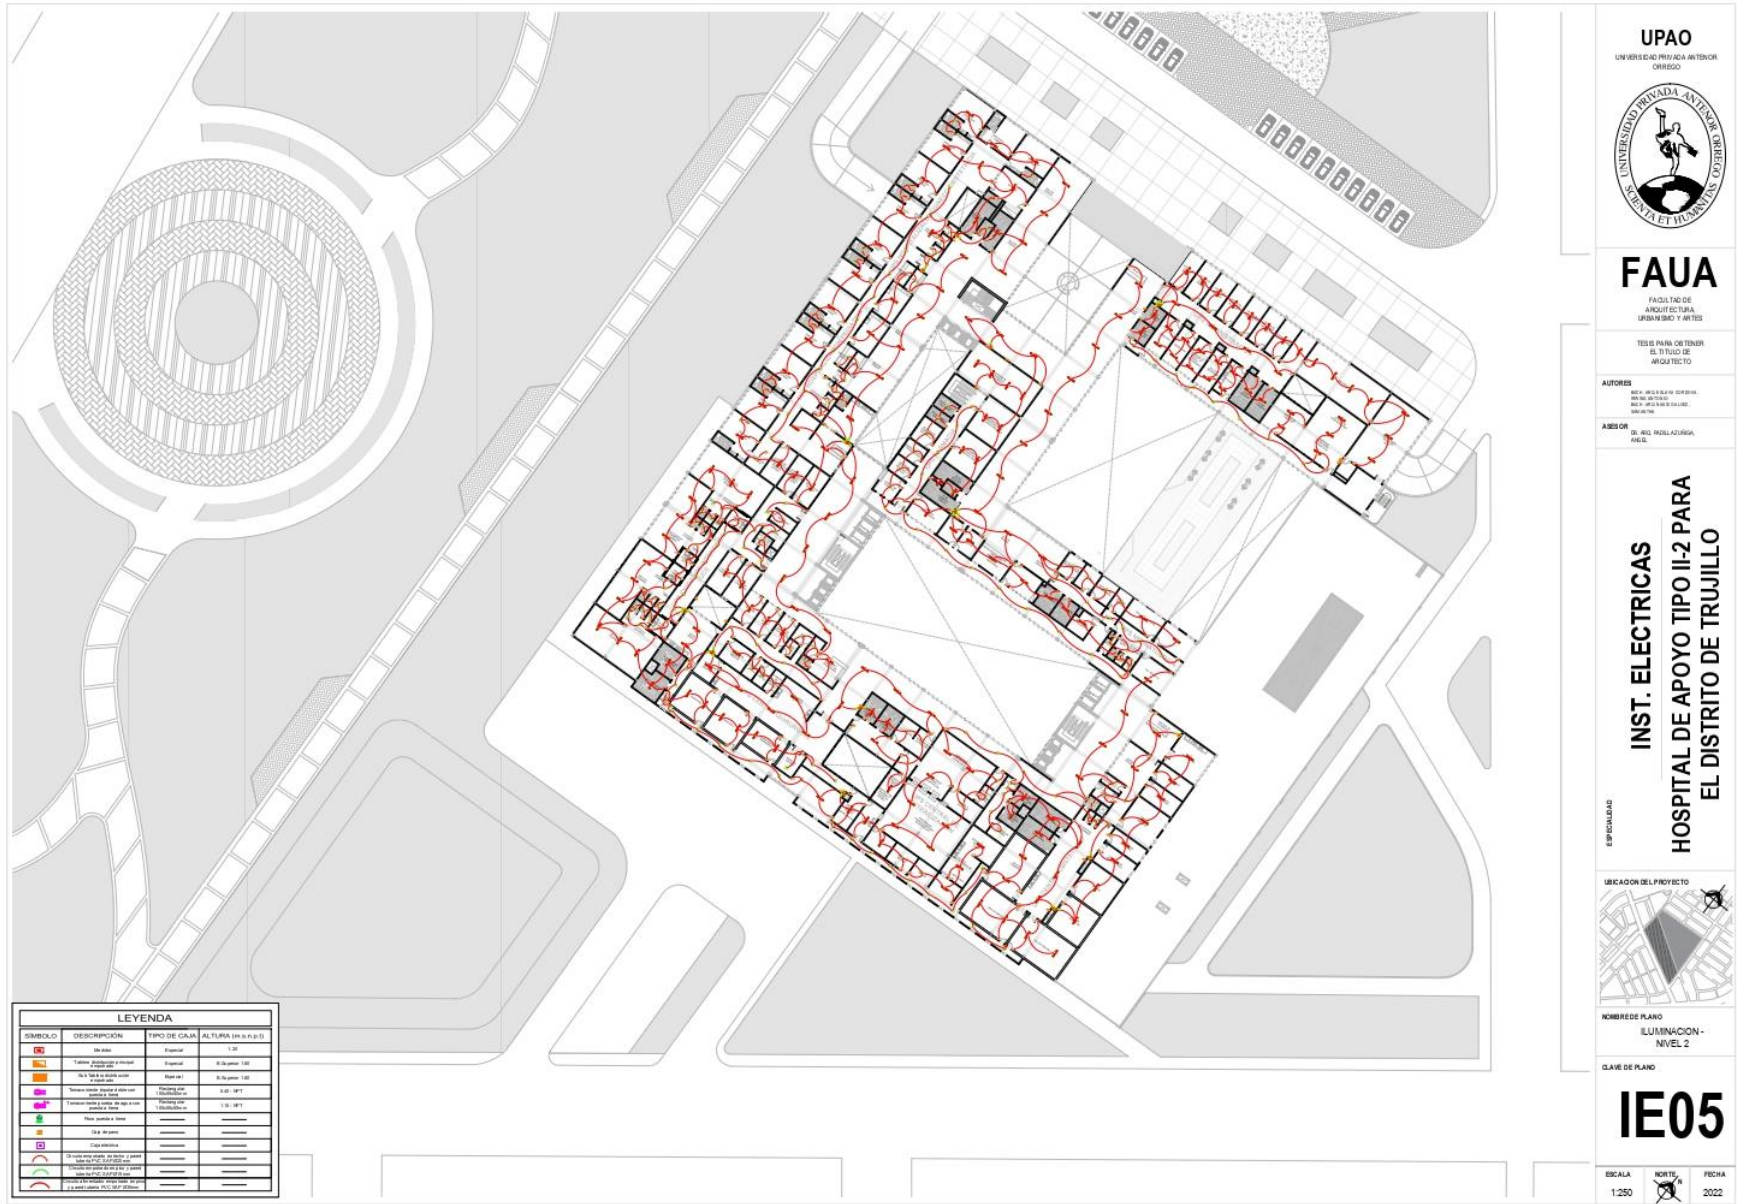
Plano de Instalaciones Eléctricas – Iluminación 2° Nivel. Fuente: Elaboración Propia
